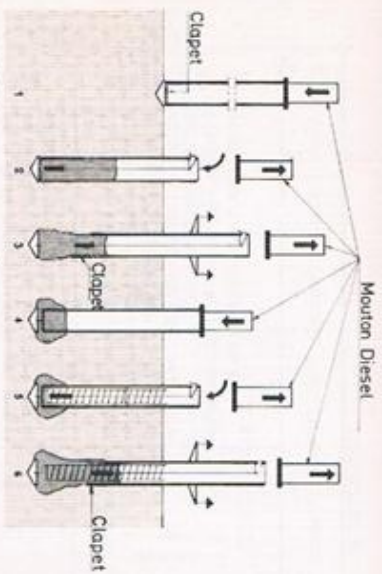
PIEUX MOULÉ DANS LE SOL A TUBE BATTU.
